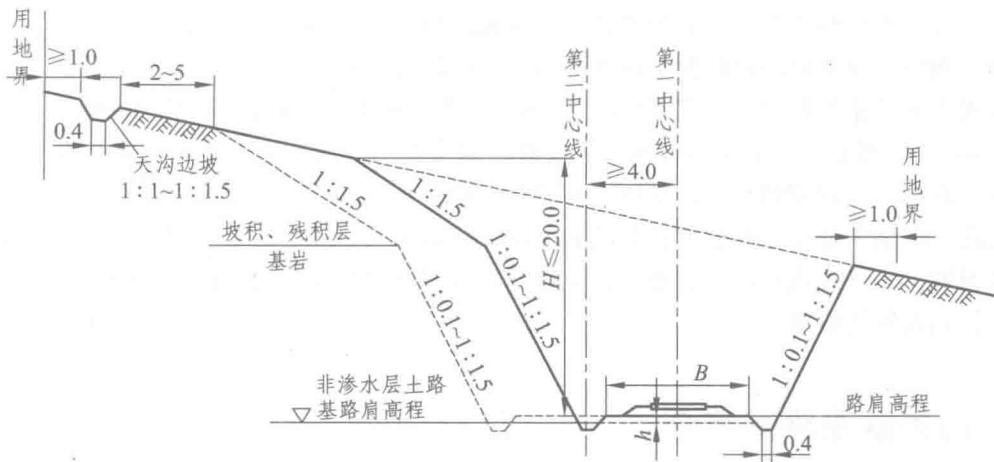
直线地段岩石路堑标准横断面图 (单位: m)
